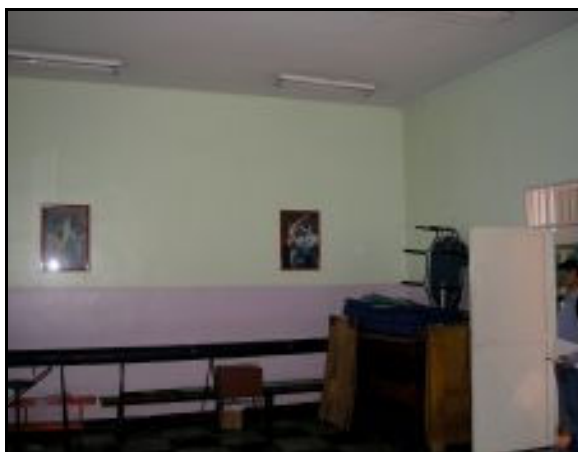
Salón de gimnasia, planta baja oeste, vista al Norte.
